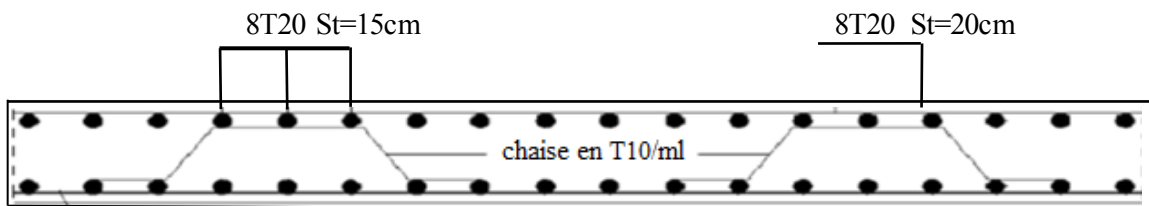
Schéma de ferrailage de la Dalle du radier
